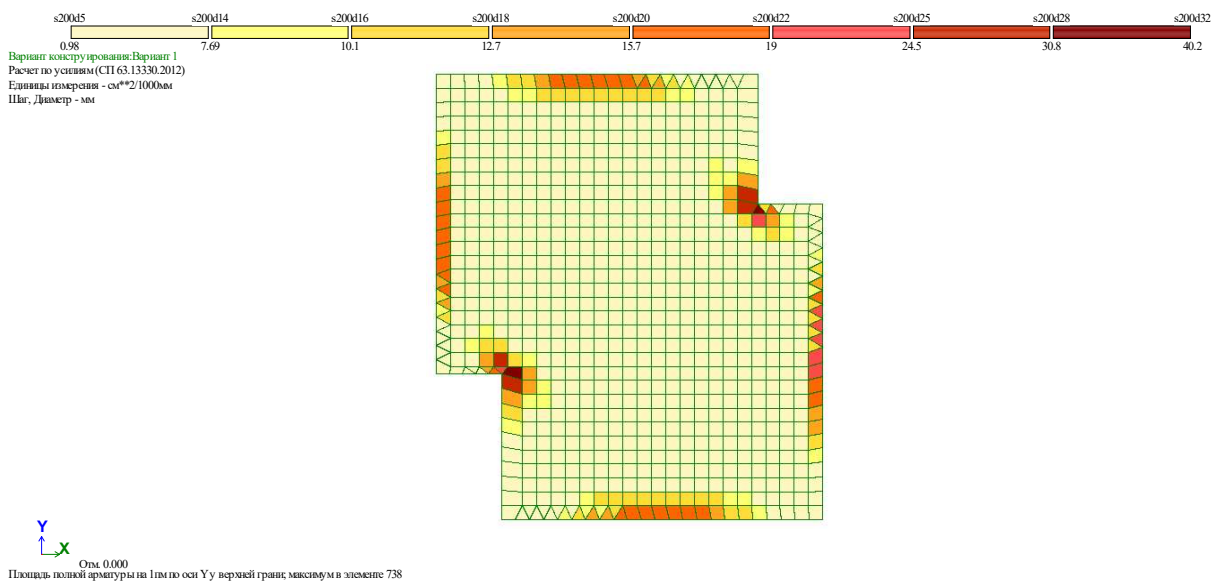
Площа арматури на 1 п.м. по осі Y у верхній грані
